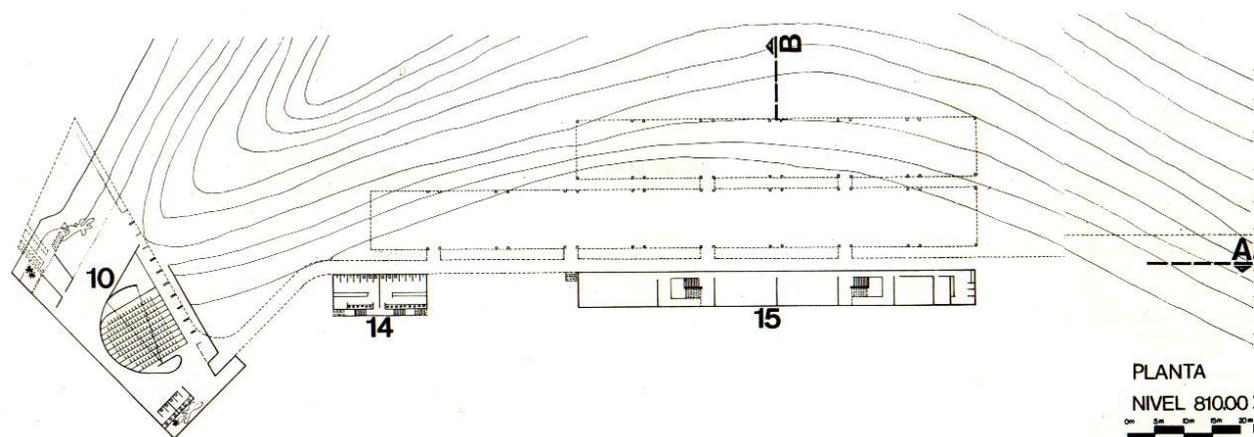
projeto vencedor, planta nível 810,00 (10-auditório; 14- vestiários; 15- instalações de apoio).
